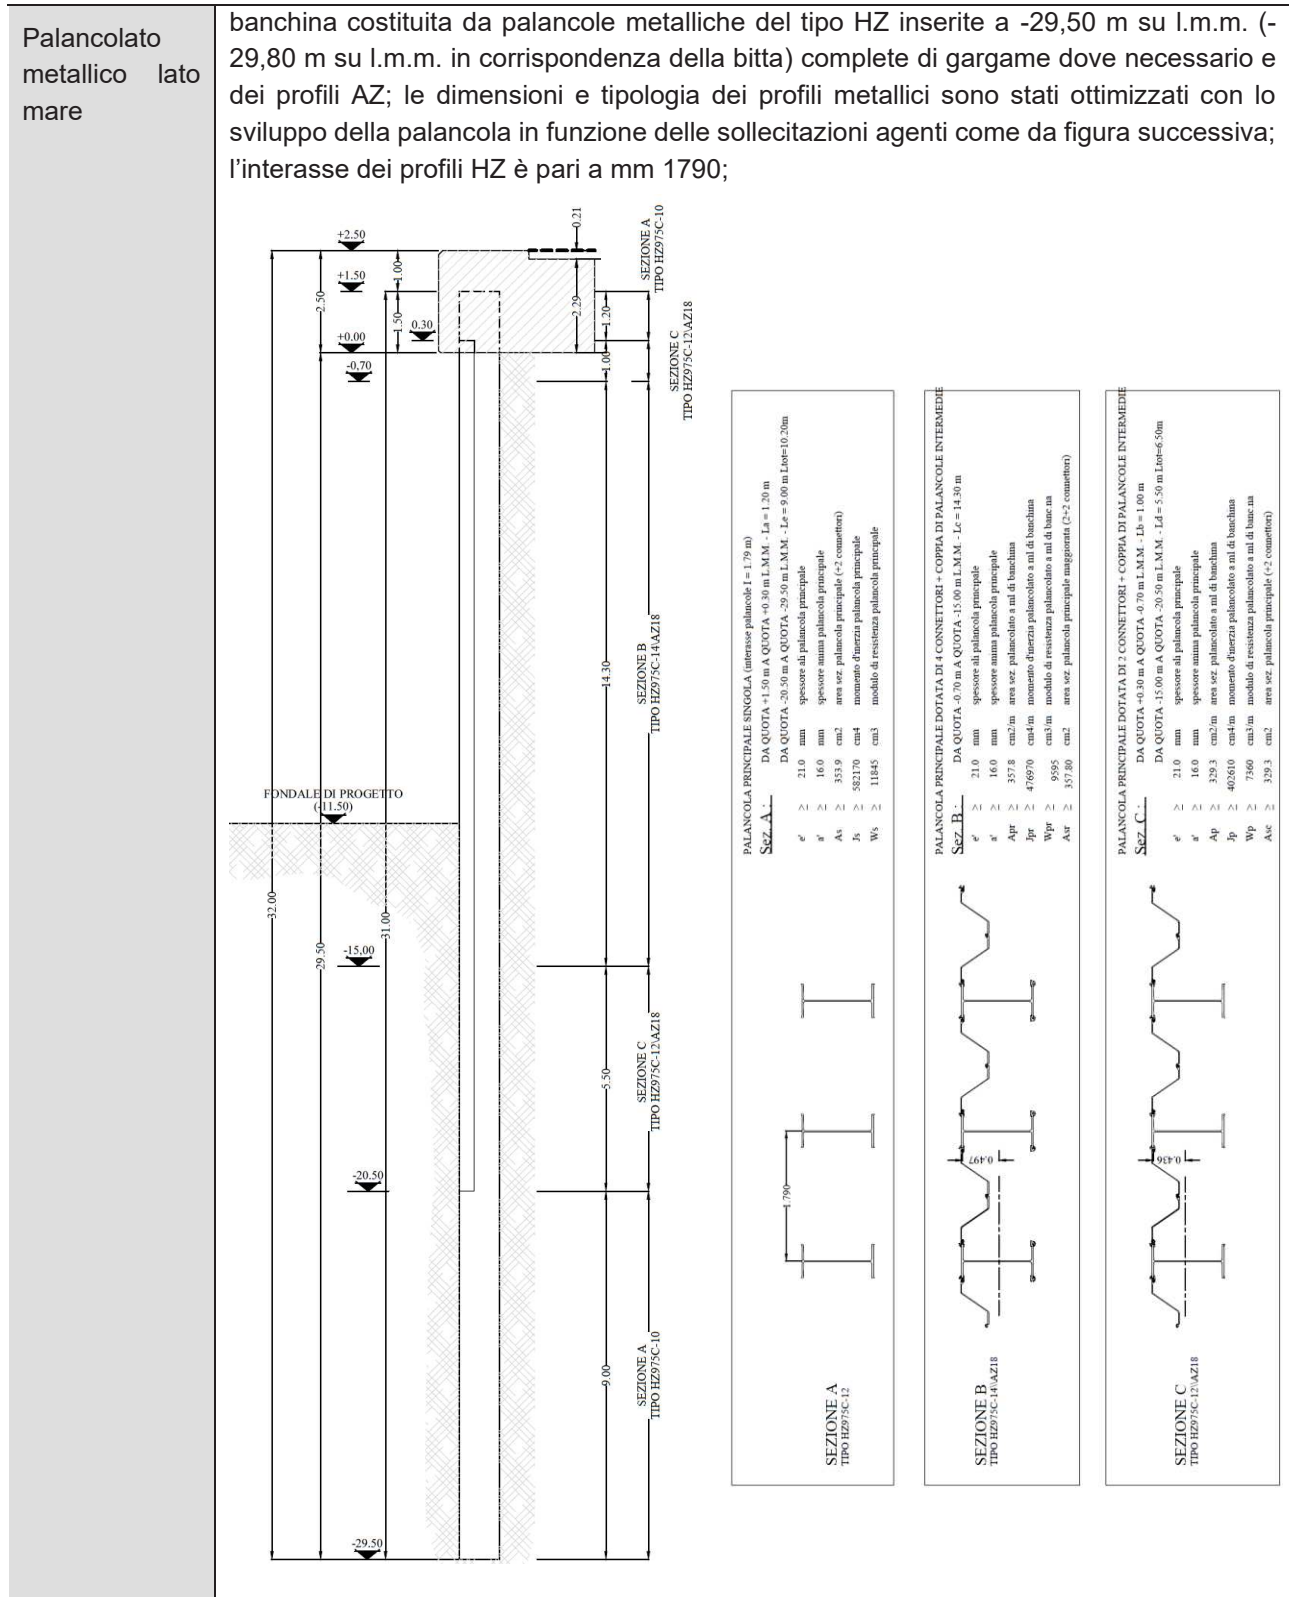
Stato di fatto - Sezione in corrispondenza delle bitte (Estratto dalla 2ª Perizia di Variante – Sezioni Tipologiche: Tiranti con Jet Grouting)
